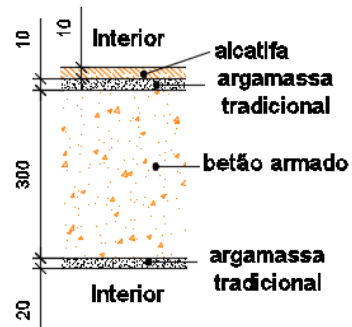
Pormenor do pavimento da envolvente interior – PAV1
